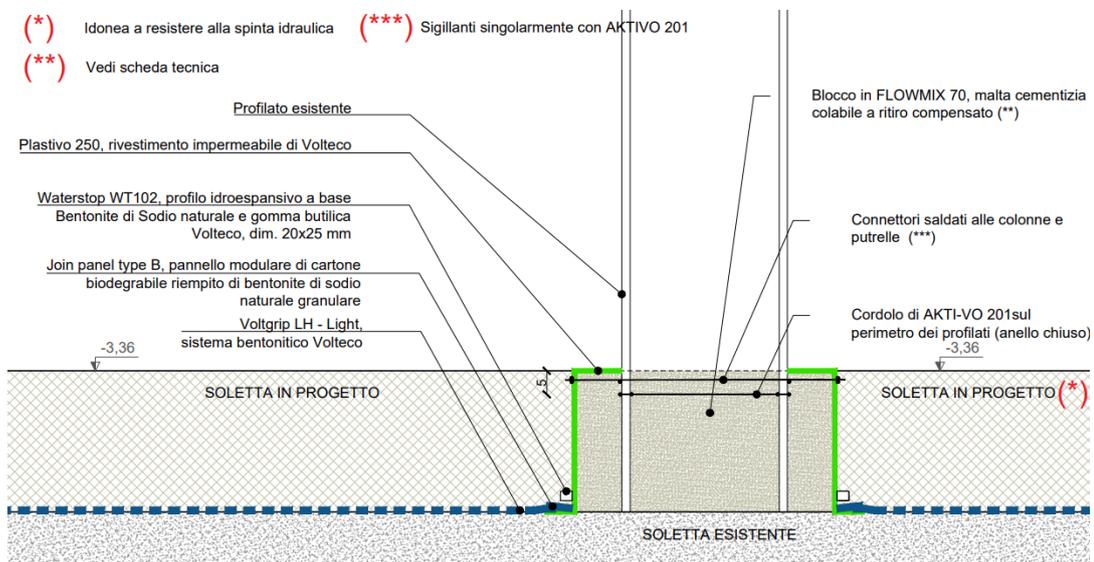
Estratto di tavola architettonica. Sezione di dettagli impermeabilizzazione-profilati in acciaio esistenti
